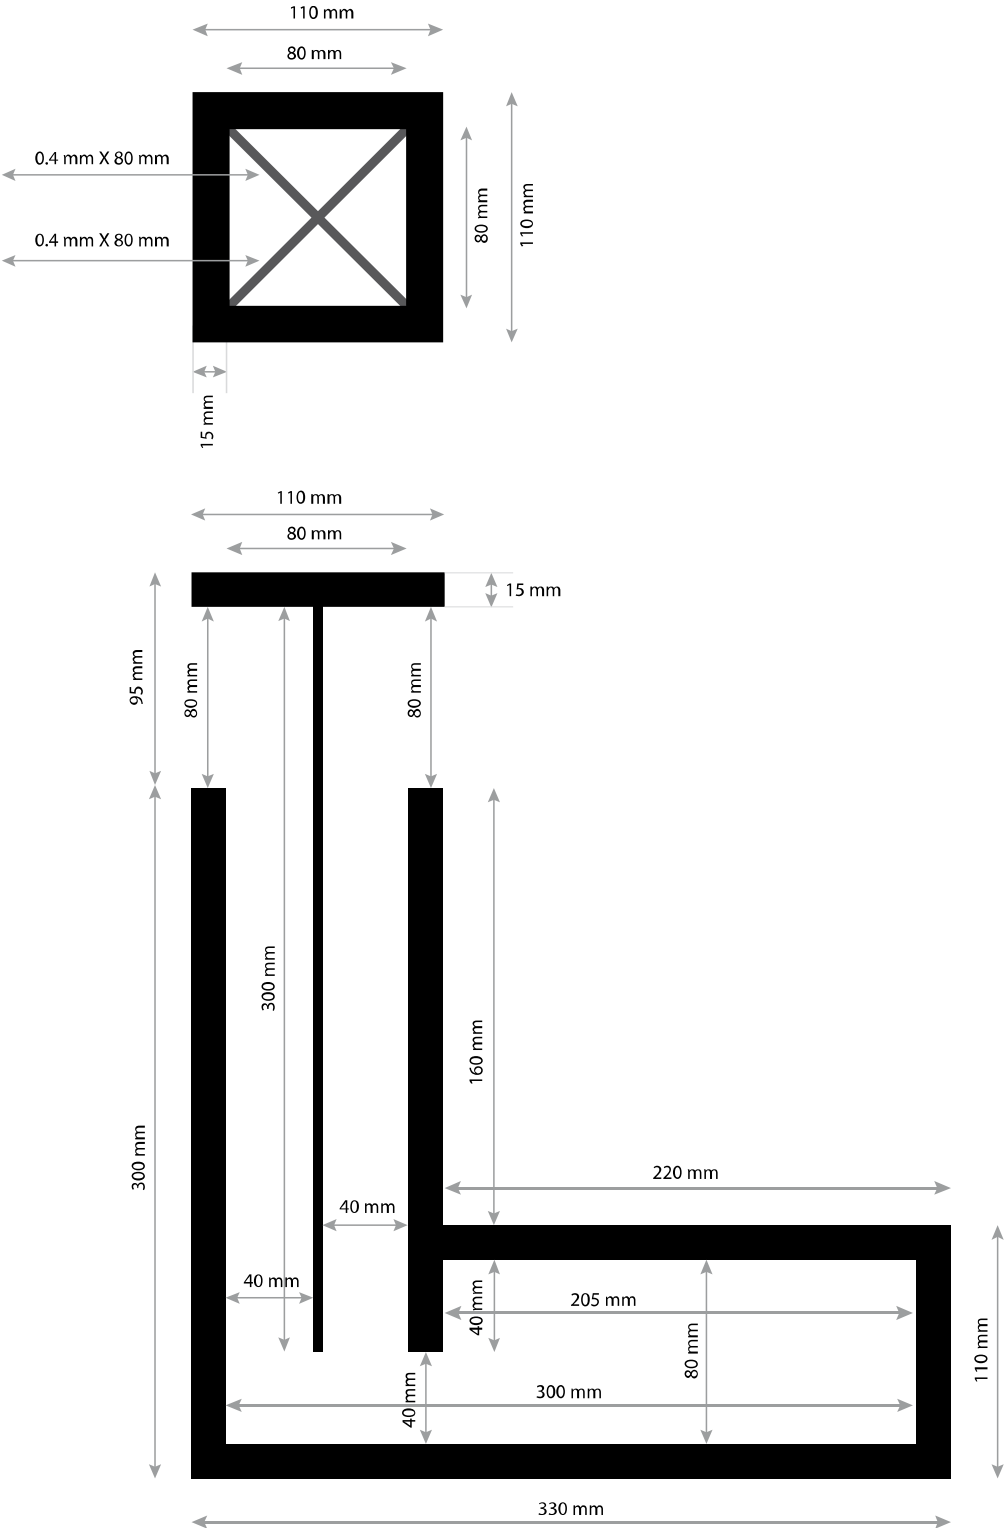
Plan et coupe de la tour et de la pièce à Badgir (pièce à vivre), échelle 1/50
